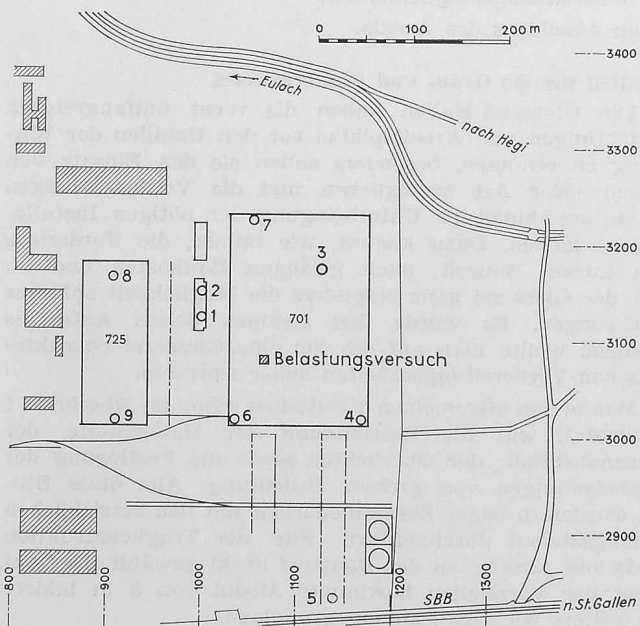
(links) Lageplan mit Angabe der Stellen, an denen Baugrunduntersuchungen durchgeführt wurden. Masstab 1:8000
